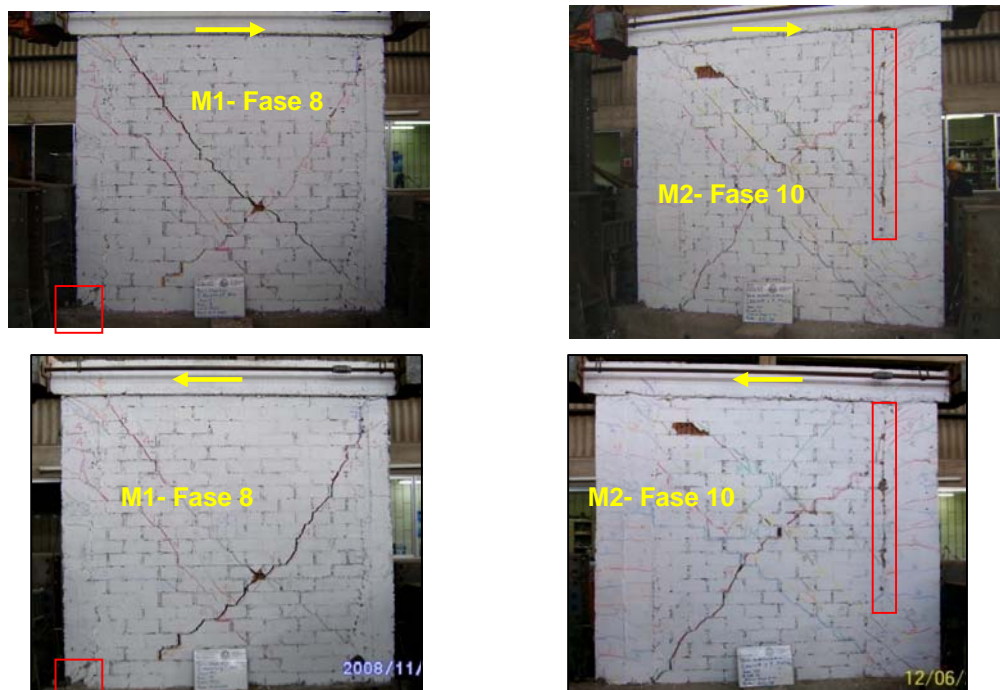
Estado de los muros en la fase final del ensayo. En las 7 primeras hiladas de la interfase albañilería-columna derecha de M2 no hubo fisura vertical.
